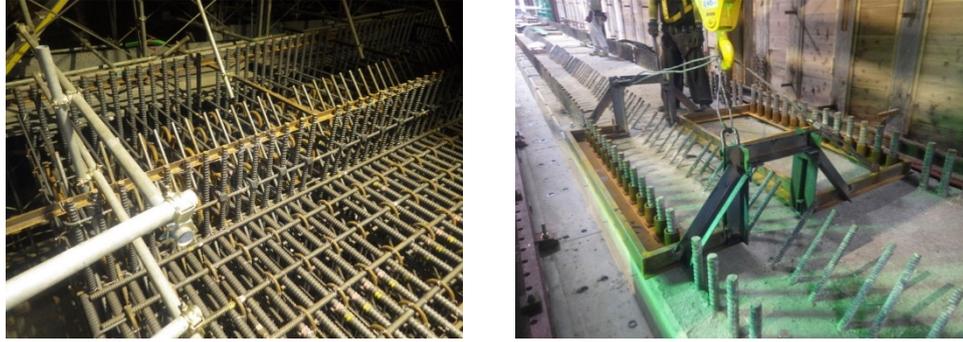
底版配筋および底版鉄筋確認状況（テンプレート使用）
